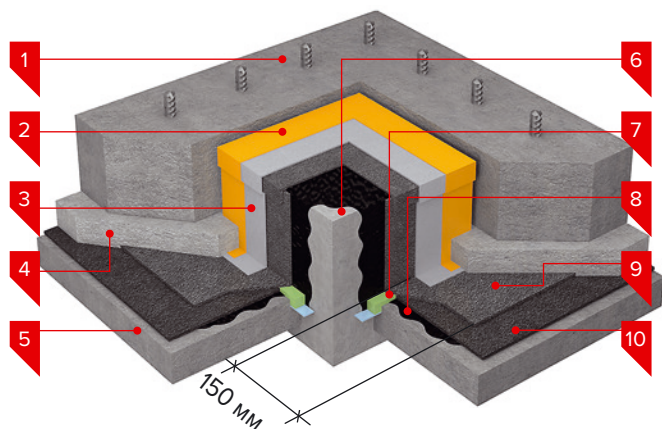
Устройство горизонтальной гидроизоляционной мембраны по свайному полю:
